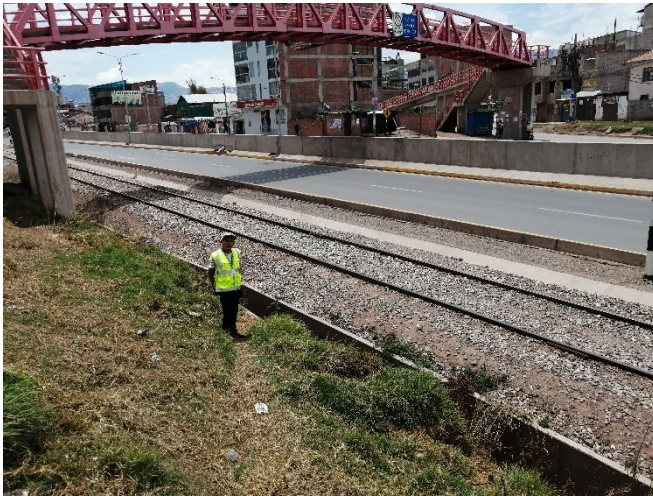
TCA N°03 – Grifo Santa Elena – San Jerónimo.
